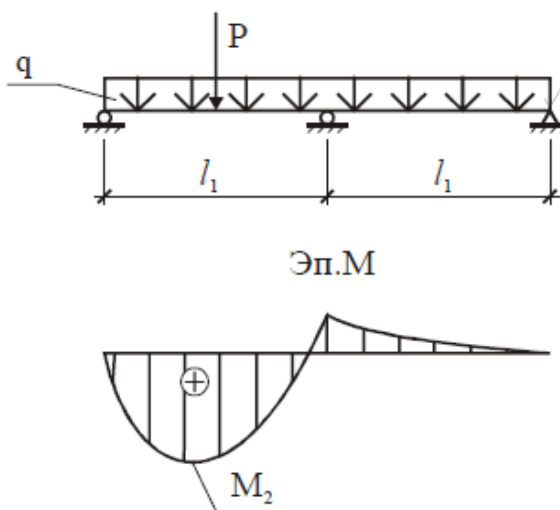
Расчетная схема обрешетки для второго сочетания нагрузок (собственный вес и монтажная нагрузка)
